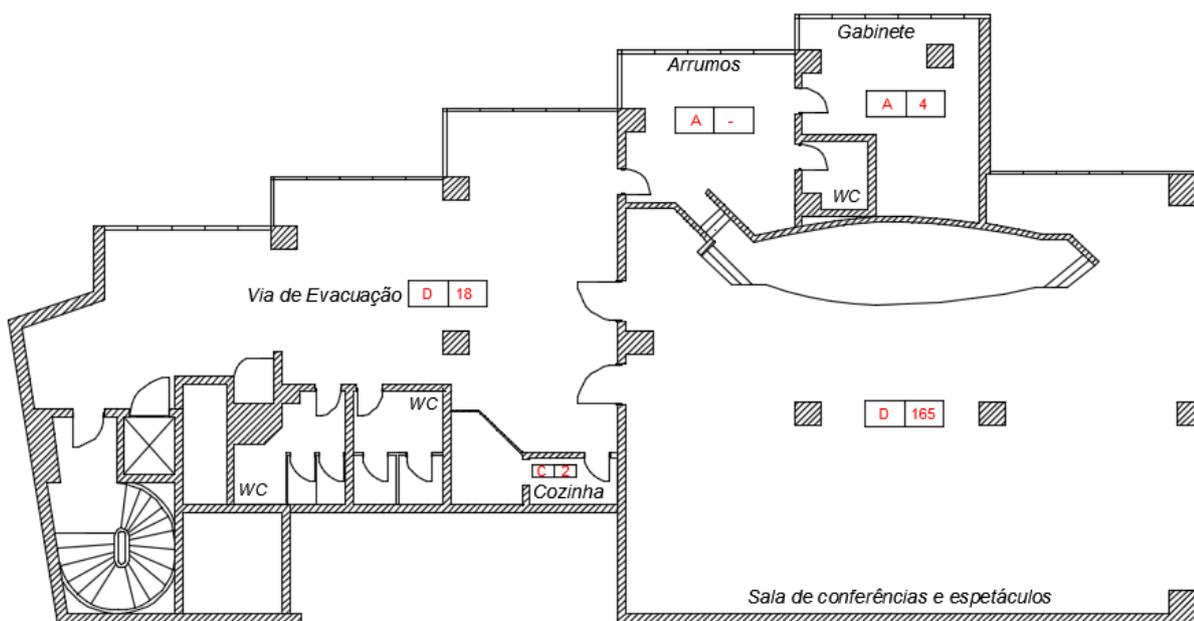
Planta do 2º piso - Local de Risco e efetivo
